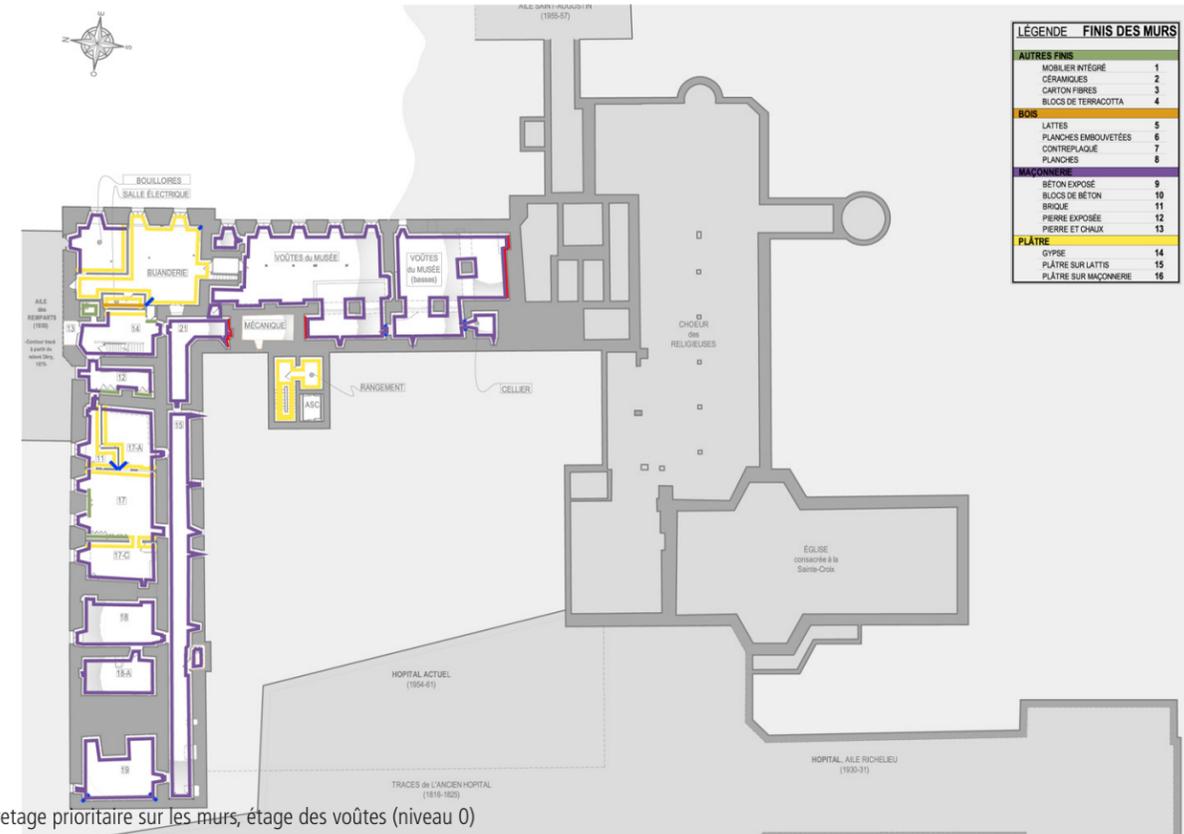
Plan de curetage prioritaire sur les murs, étage des voûtes (niveau 0)
